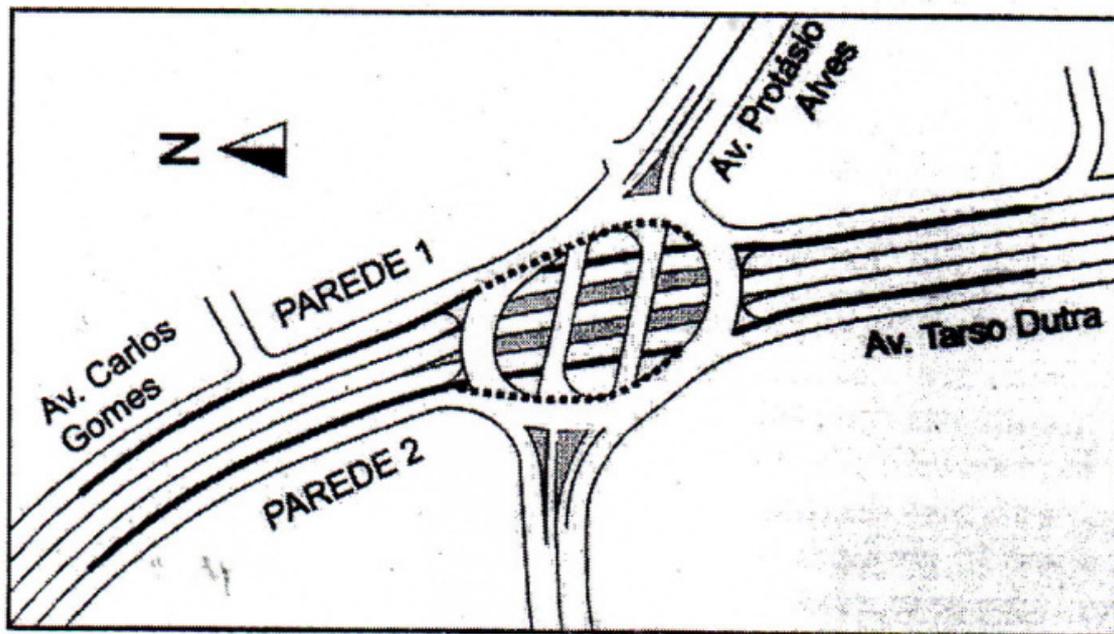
Croqui em vista superior da estrutura do Viaduto Jorge Alberto Mendes Ribeiro.
